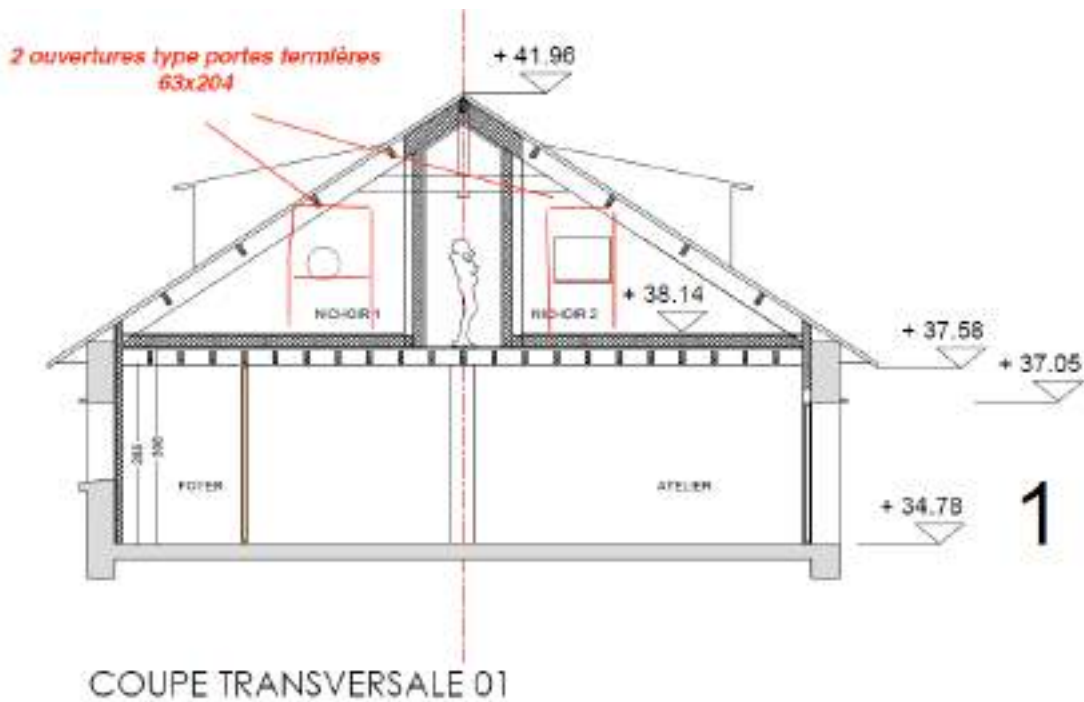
coupe transversale du bâtiment, extrait du permis de construire
